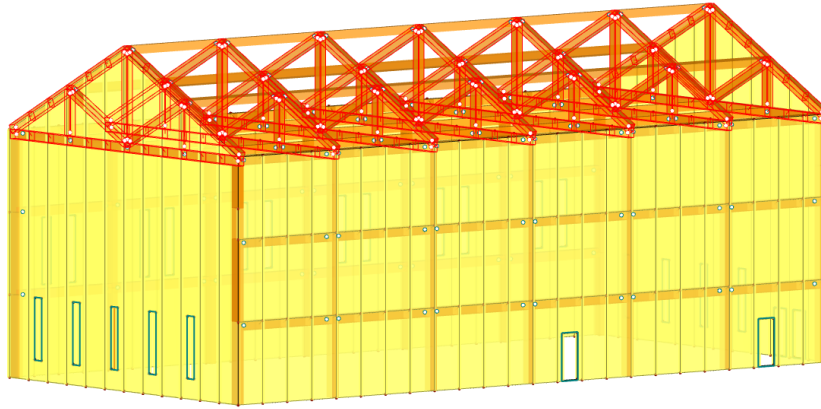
Correas de fachada de la nave de la piscina.
